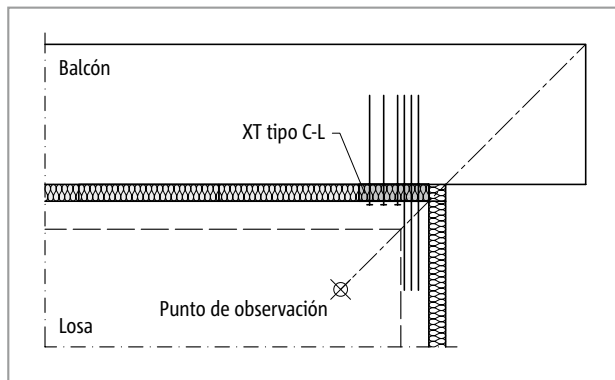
Schöck Isokorb® XT tipo C: Balcón voladizo sobre la esquina del edificio (utilización de XT tipo C-L)
